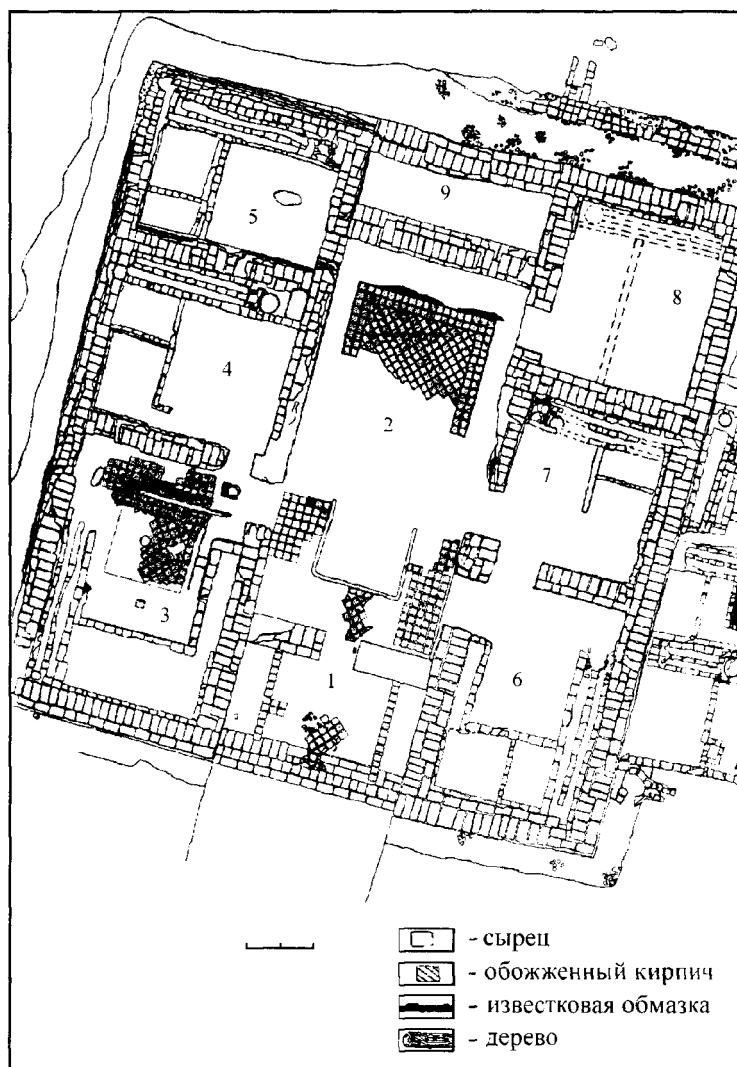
Здание на XV раскопе, общий план конструкций I строительного периода.
